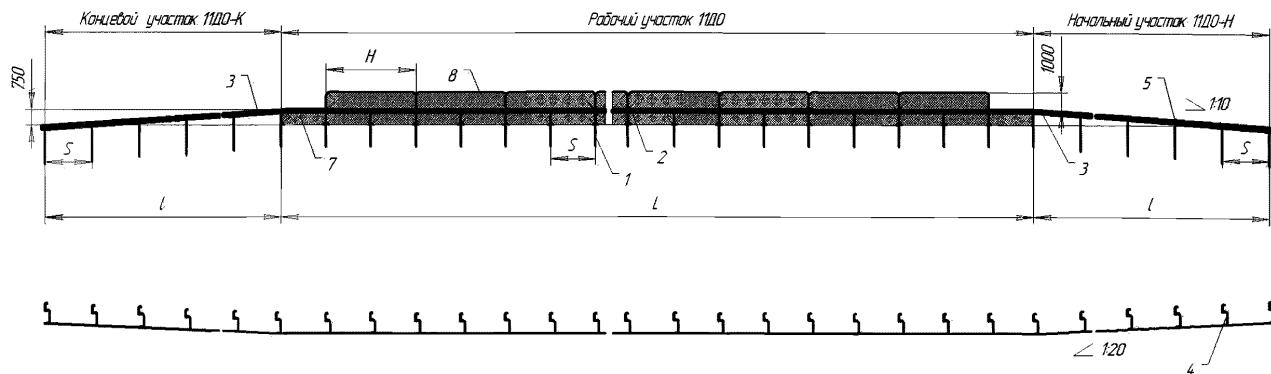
Схема сборки 11ДО/У5-У7(350-450)-0,75-разборное
